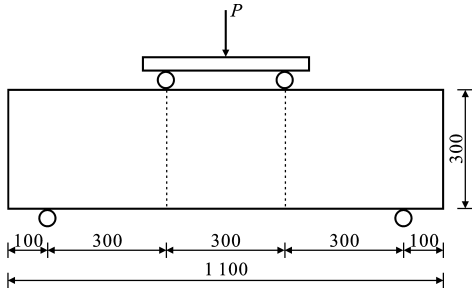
三级配混凝土梁弯拉试验示意(单位:mm)
